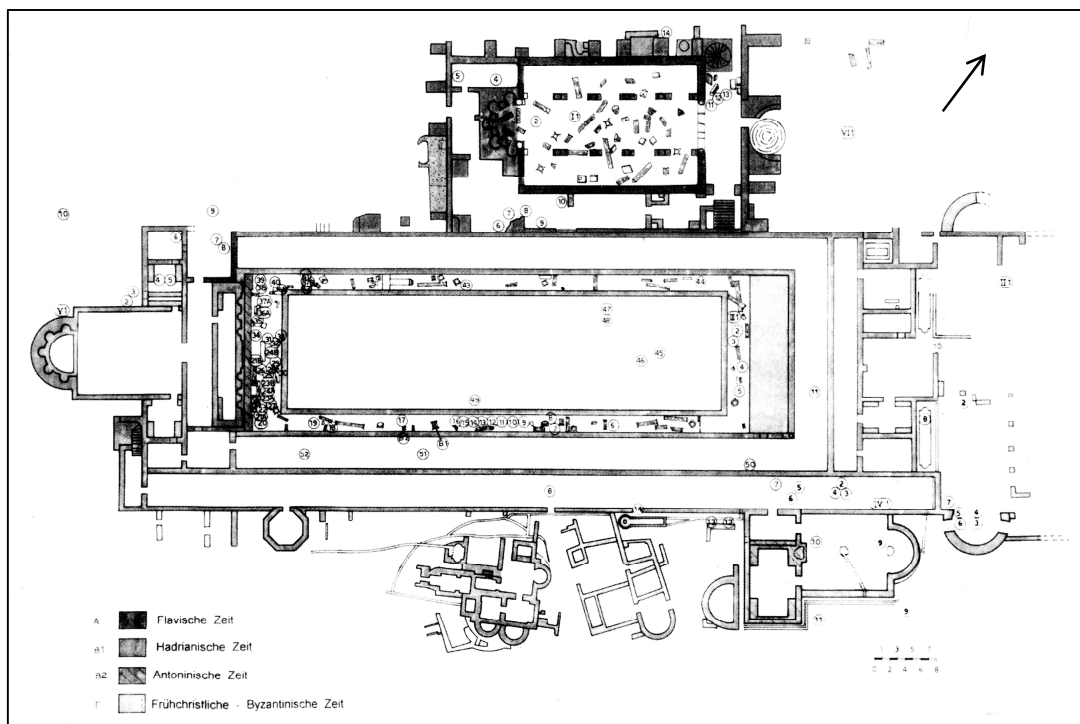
Planimetria della villa di Erode Attico a Eva (SPYROPOULOS 2001, p. 208)
